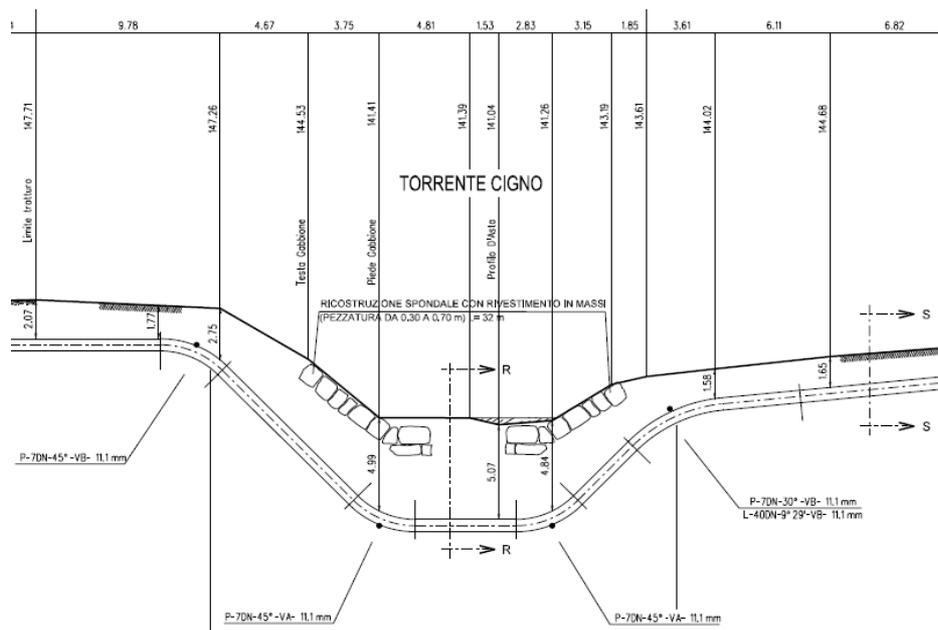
Attraversamento torrente Cigno - Sezione schematica di progetto
